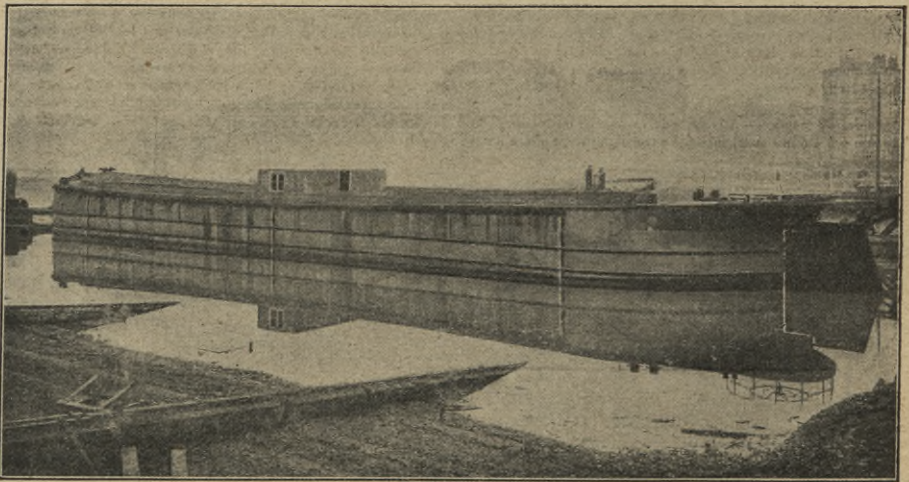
Eisenbetonschute, Bauweise Lorton, Paris.
